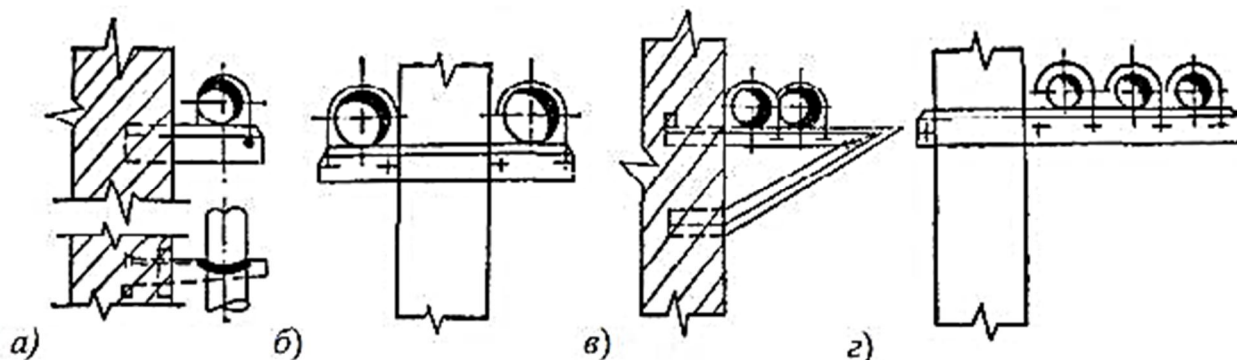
Схема крепления труб при помощи кронштейнов: а, в – крепление к стенке; б, г – крепление к колонне
